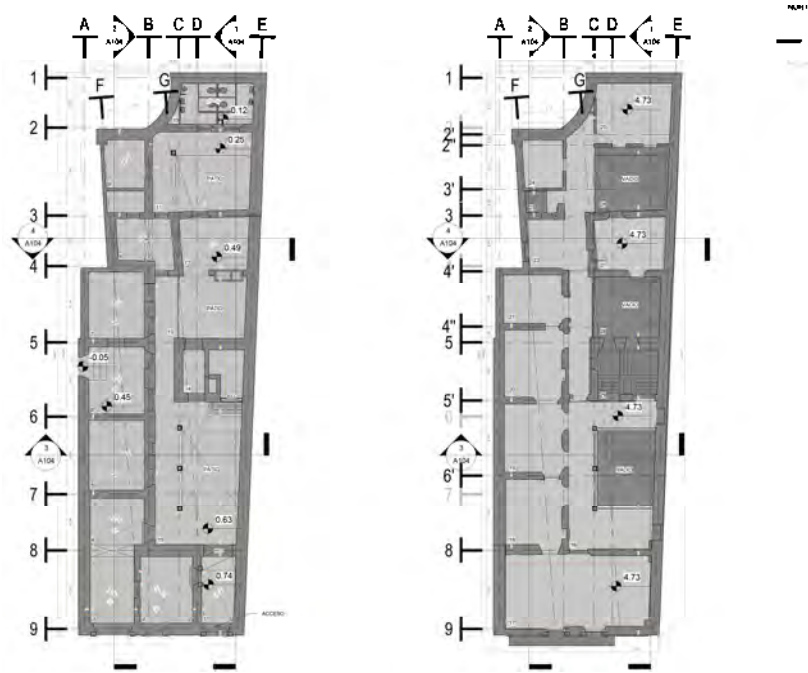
Plantas arquitectónicas baja y alta, de la CAMEM en limpio con el software Revit 2021. Elaboró: METR
